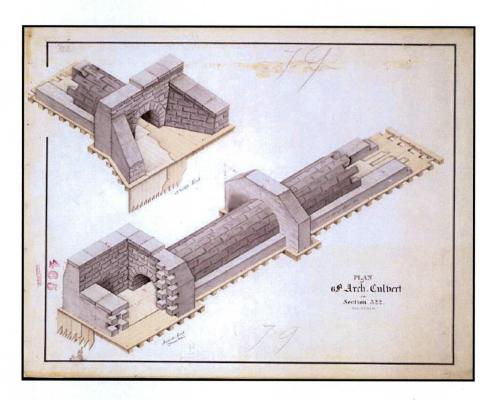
Plan of 6 Ft. Arch-Culvert on Section 322. Cet aqueduc est intégré au canal Érié, dont la partie originale est complétée en 1825. Collection New York State Archives.
